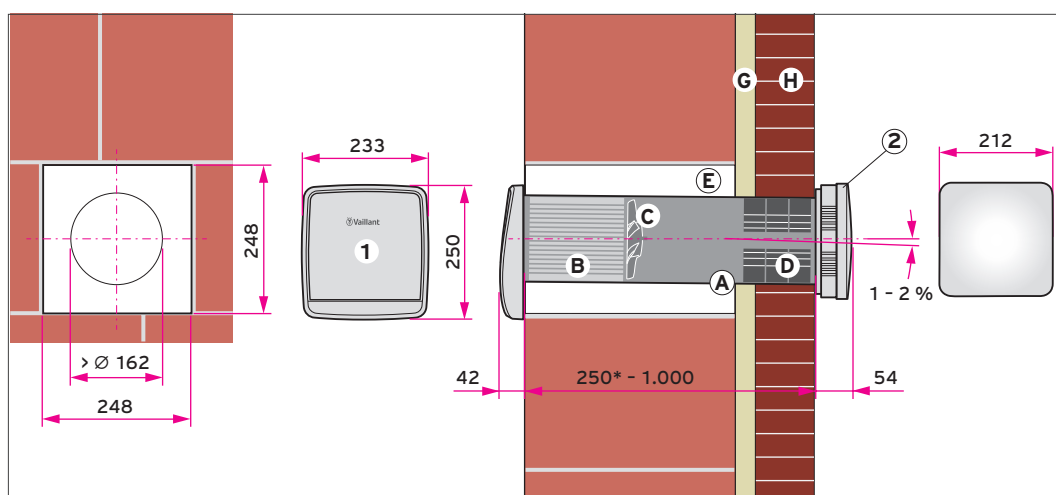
Fassadendurchführung im Montageblock bei Vorsatzschale aus Klinkermauerwerk
